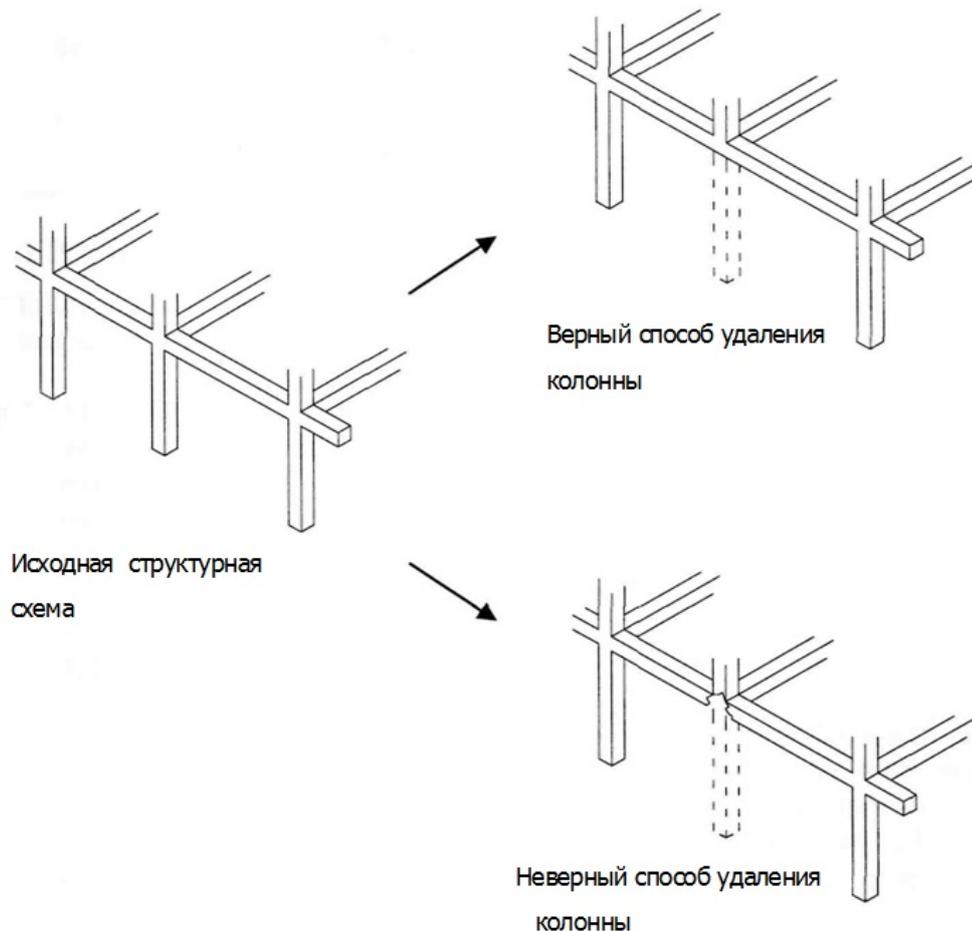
Эскиз верного и неверного способа удаления колонны
